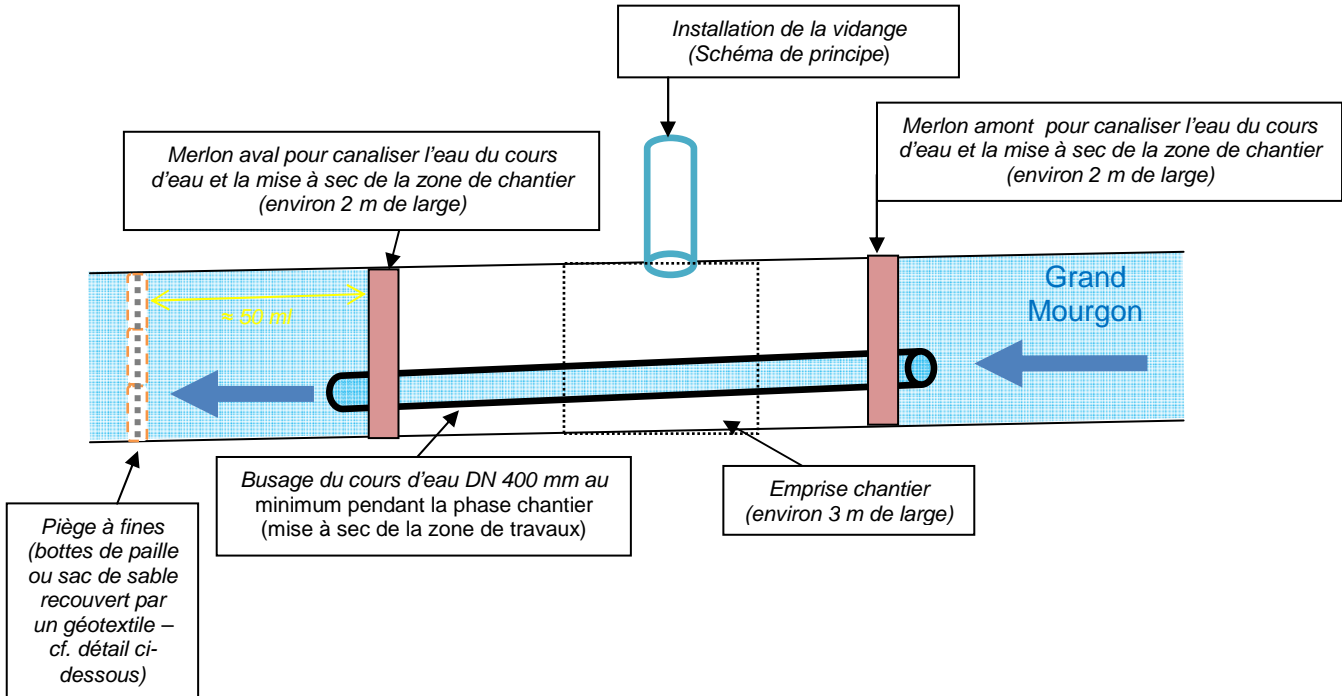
Schéma de principe de la zone des travaux en phase chantier (vue en plan)
